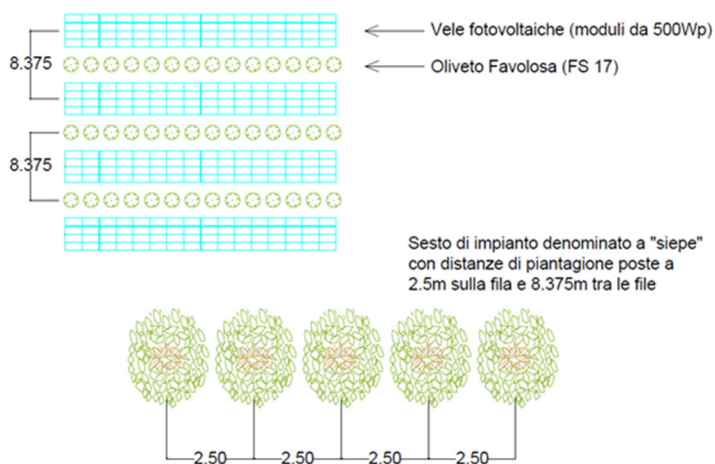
Dettaglio disposizione planimetrica pannelli.
